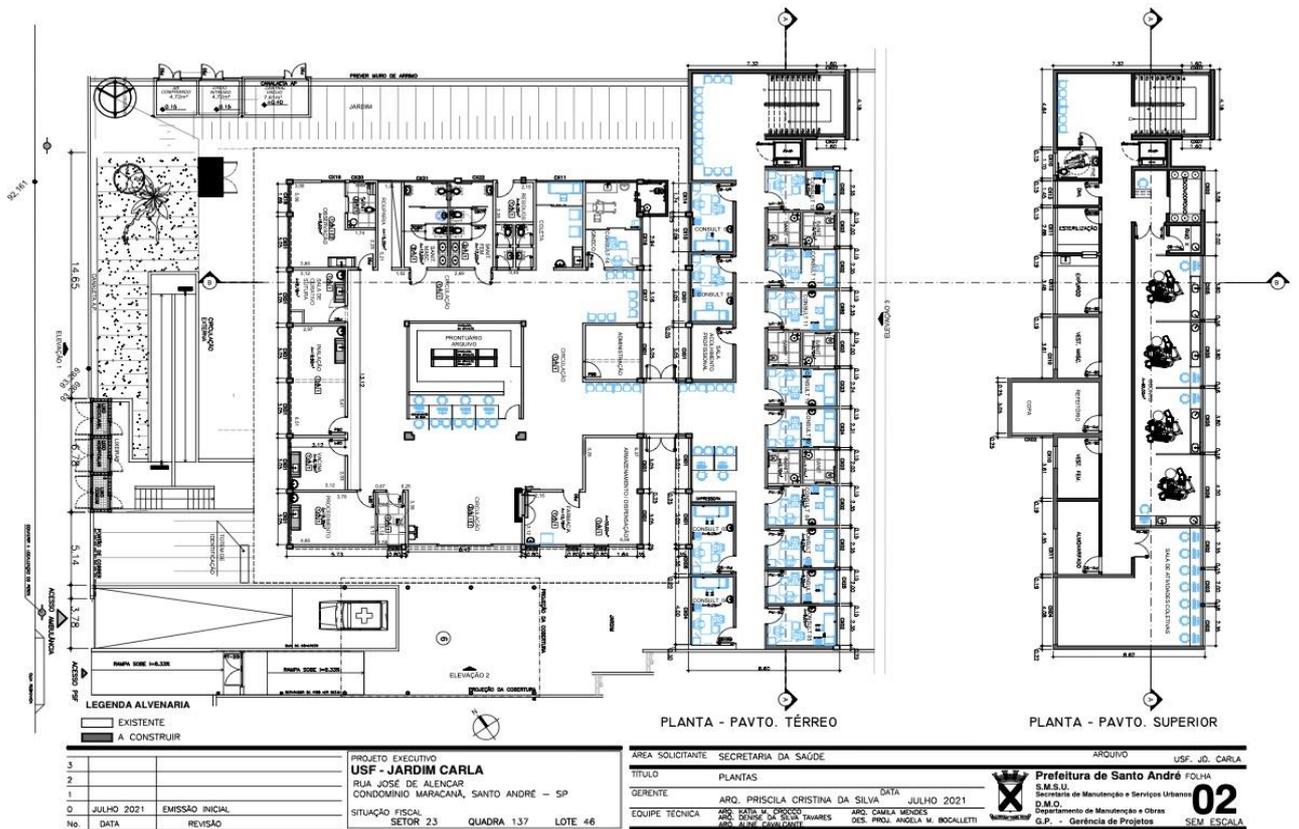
Planta da USF Jardim Carla, mostrando as áreas que serão construídas no térreo e no primeiro pavimento.
